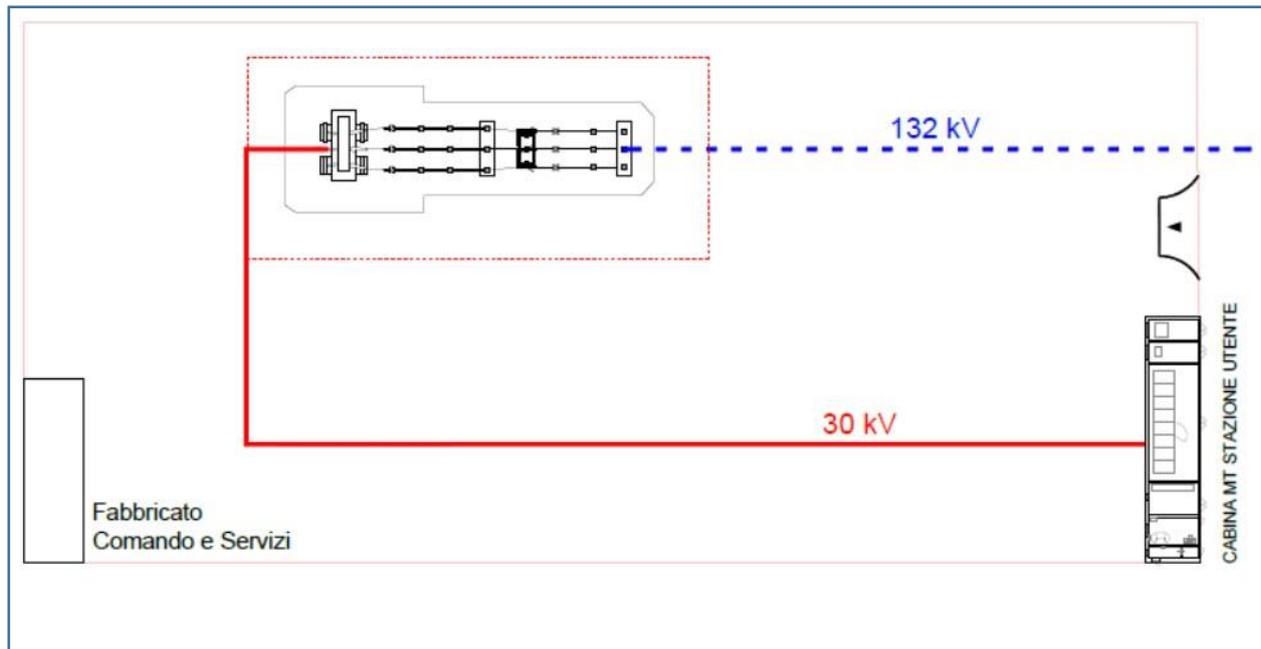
SEZIONE TIPO PROGETTUALE (SI VEDANO TAVOLE DI PROGETTO)
